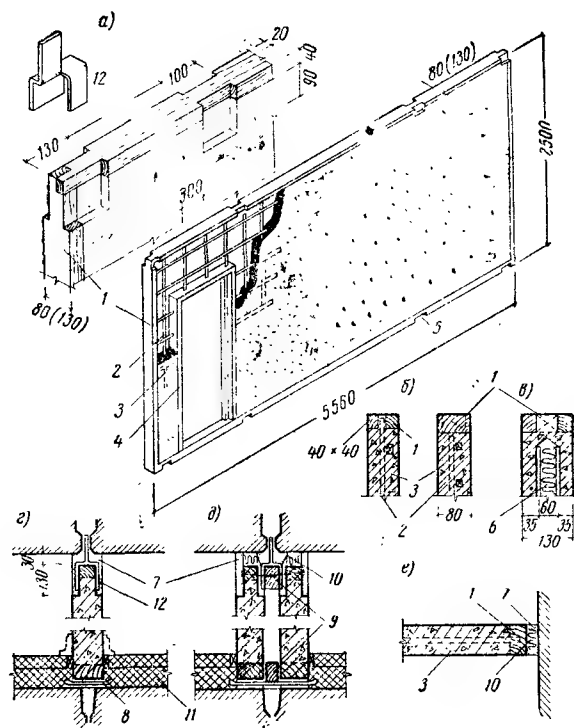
Гипсобетонные крупнопанельные перегородки
